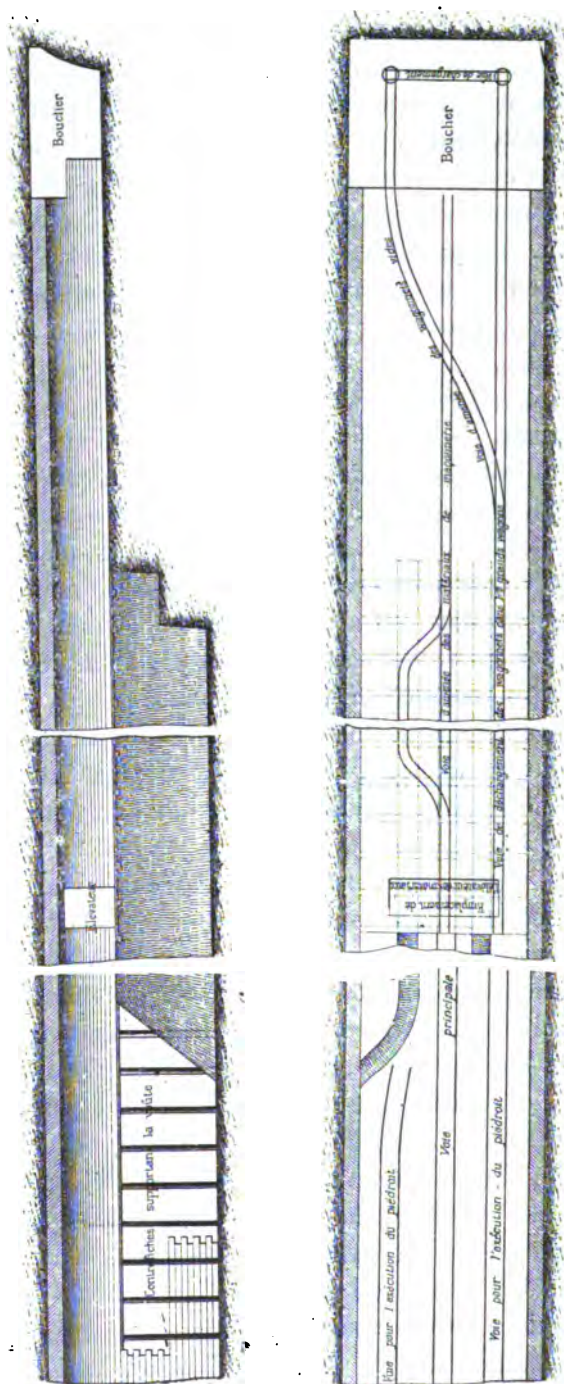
Disposition générale du chantier ; coupe longitudinale et plan.
